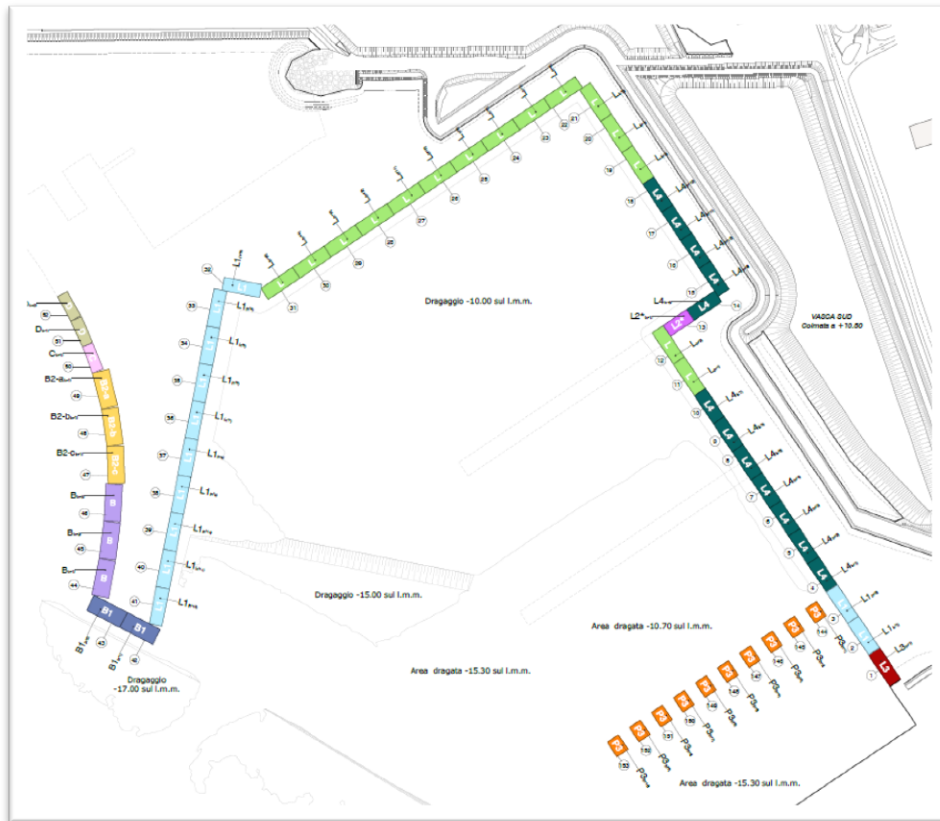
Stralcio planimetria classificazione cassoni Perizia di Variante N°1
